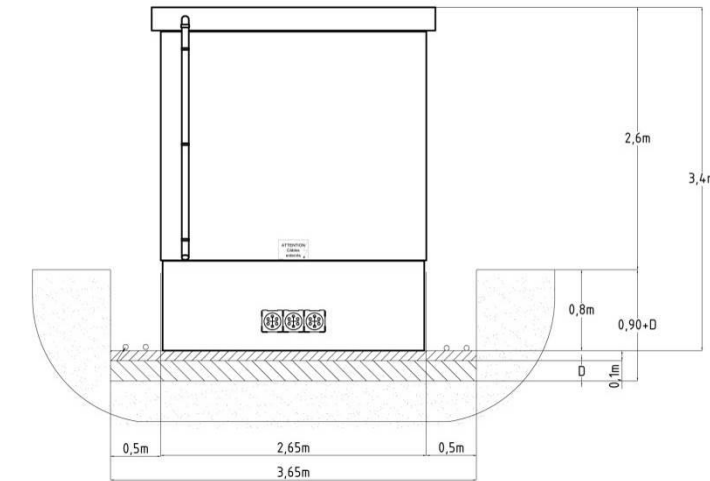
Plan de façade d'un poste de livraison (vue de profil)
